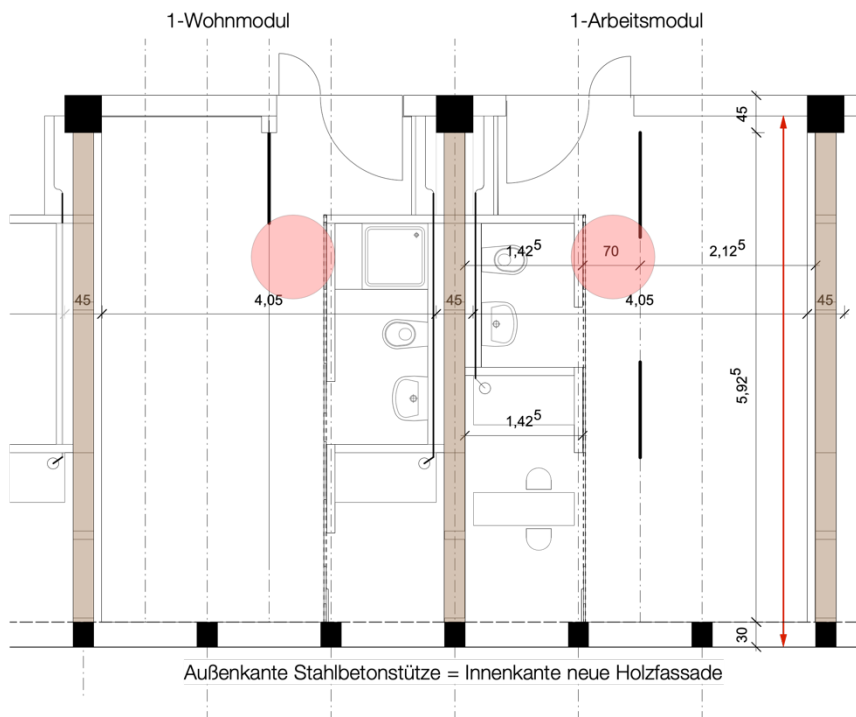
Überprüfung der Grundrissgeometrie der kleinstmöglichen Einheit bei Untersuchungsobjekt 1
